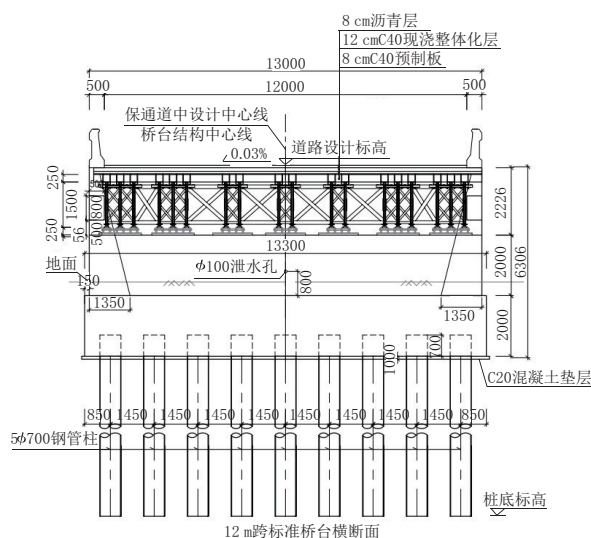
原设计方案钢便桥桥台处横断面图(单位:mm)
